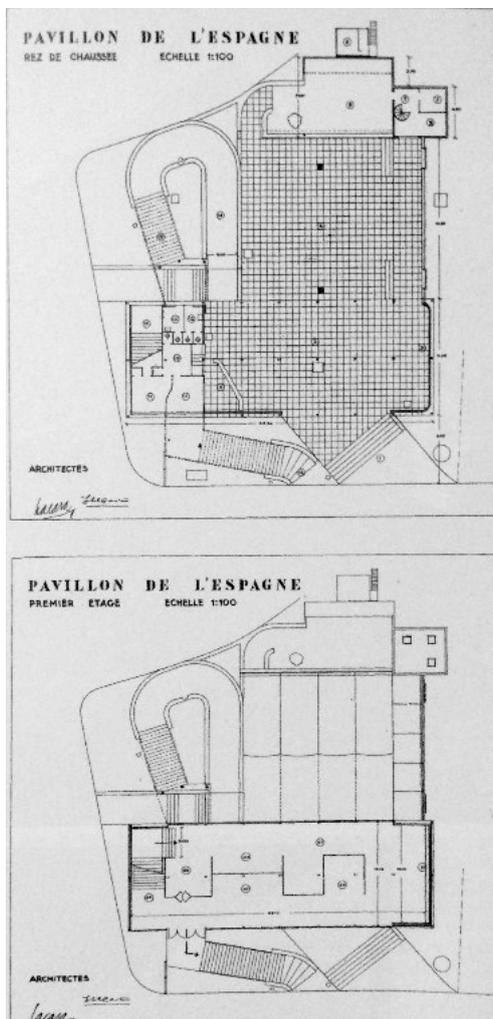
Planos de la planta baja y primera planta del pabellón de la República de 1937.
